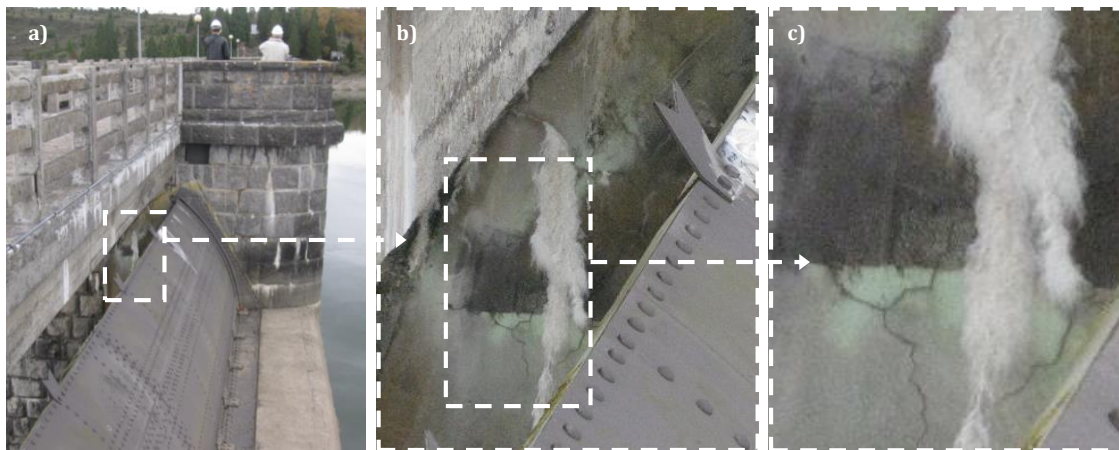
Fisuración enramada en la zona de compuertas: a) general; b) y c) detalles
